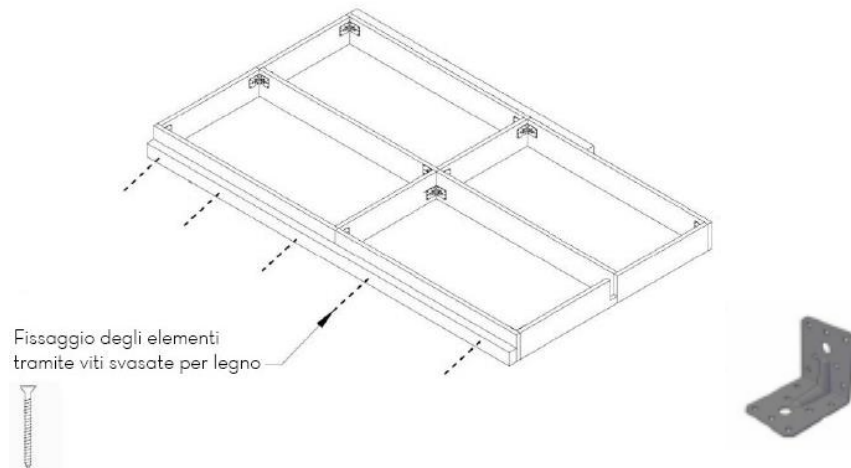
, Fase di montaggio della cassa rigida strutturale. Fonte autore tesi
